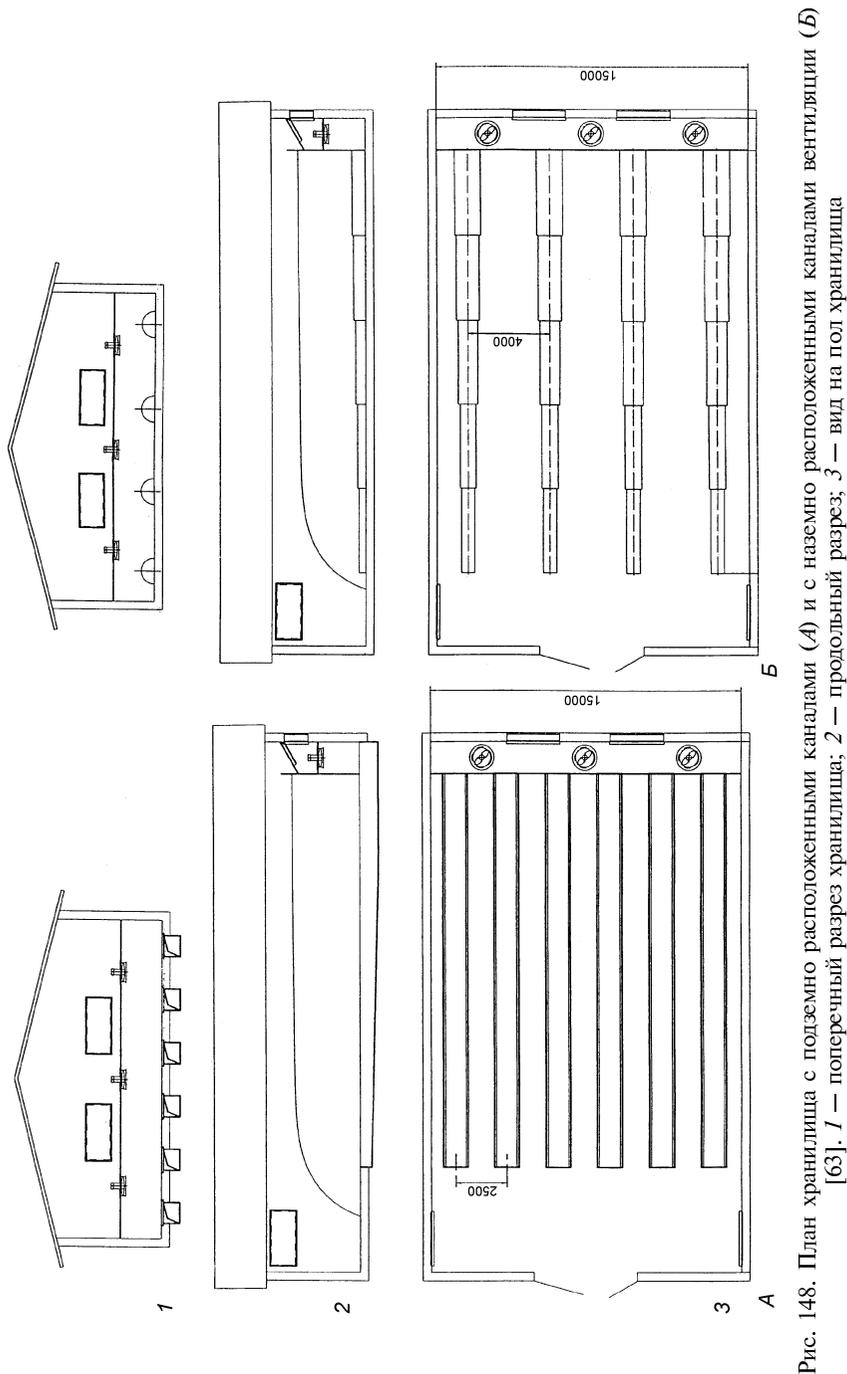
План хранилища с подземно расположенными каналами (А) и с наземно расположенными каналами вентиляции (Б) [63]. 1 — поперечный разрез хранилища; 2 — продольный разрез; 3 — вид на пол хранилища
